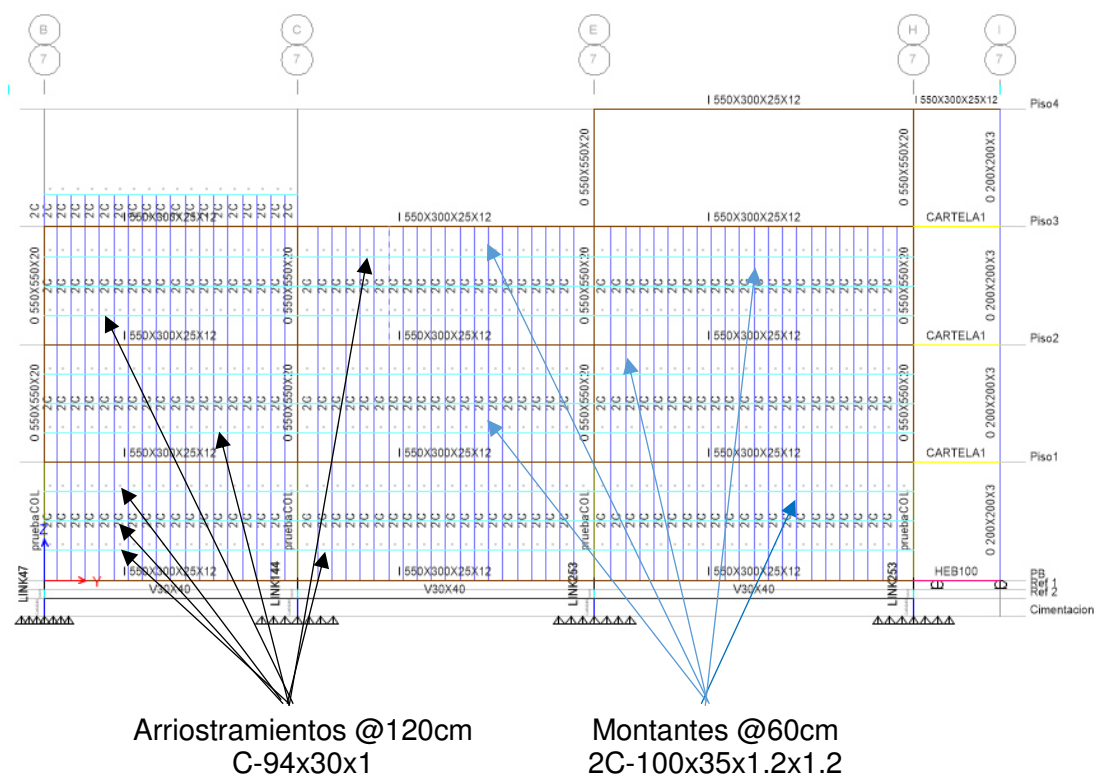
Distribución de elementos del entramado Steel Framing eje 7.
